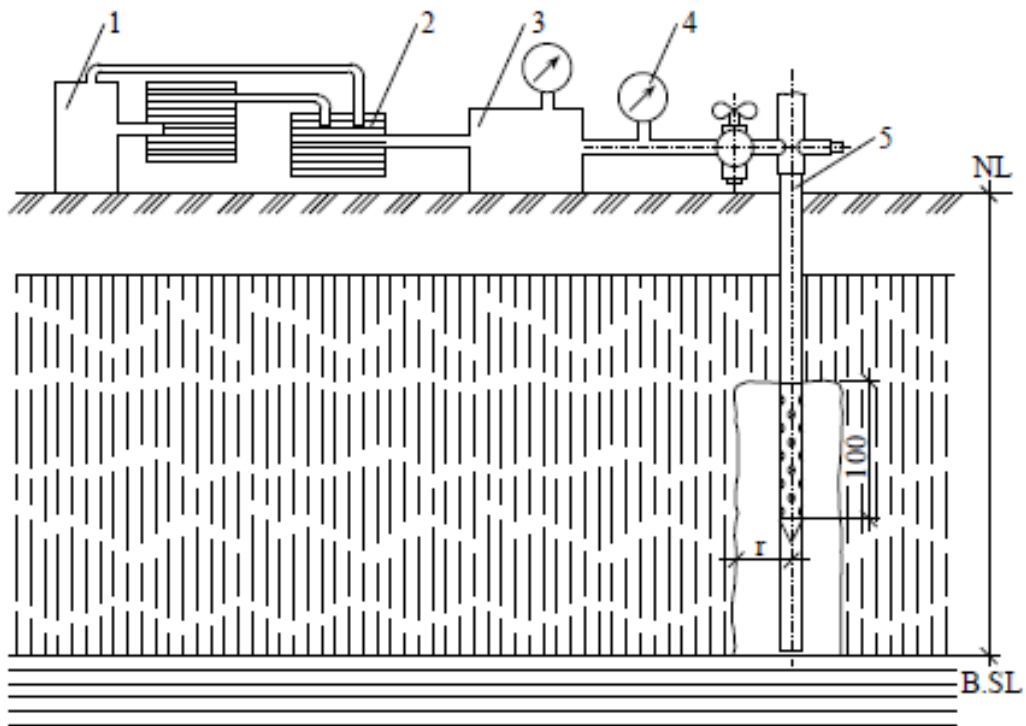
Схема силікатизації ґрунту: 1 – паровий котел; 2 – місткість для приготування розчину; 3 – насос для нагнітання розчину в ґрунт; 4 – реєстратор тиску; 5 – ін’єктор для подачі розчину в ґрунт; r – радіус закріплення в ґрунт
